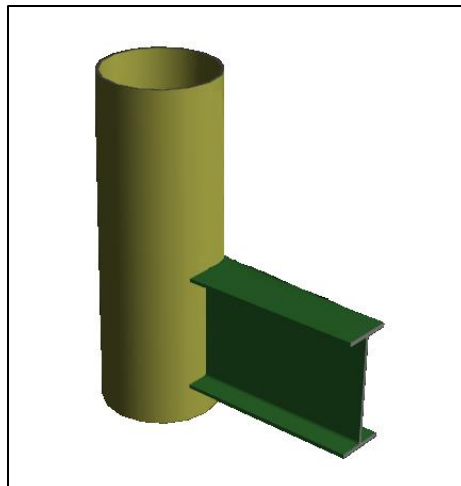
Struktur Sambungan Balok Kolom
